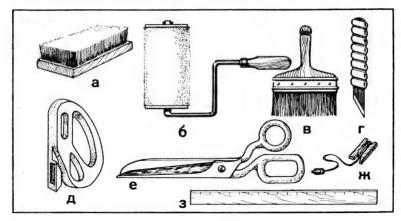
Инструменты для обойных работ: а — щетка; б — резиновый валик; в — кисть-флейц; г — нож; д — нож для обрезания кромок; е — ножницы; ж — отвес; з — линейка
